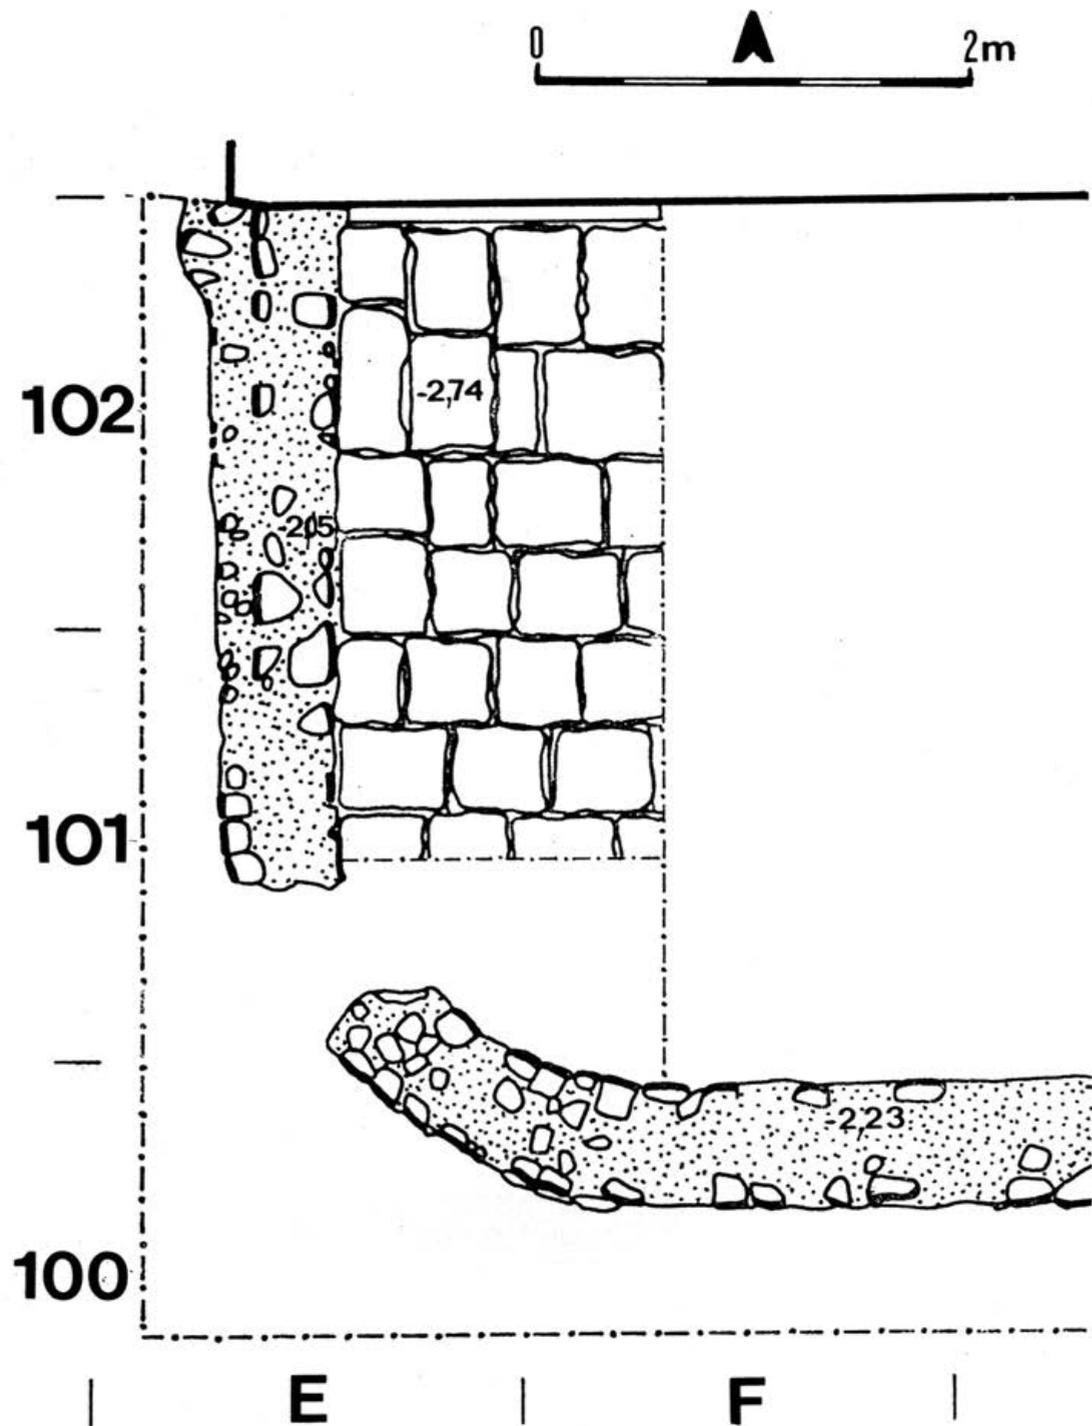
Largo de Jesus. Planta da extremidade oeste do “fosso” construído no primeiro quartel do séc. XX. Atenda-se aos negativos das lajes que pavimentavam o interior do fosso.
